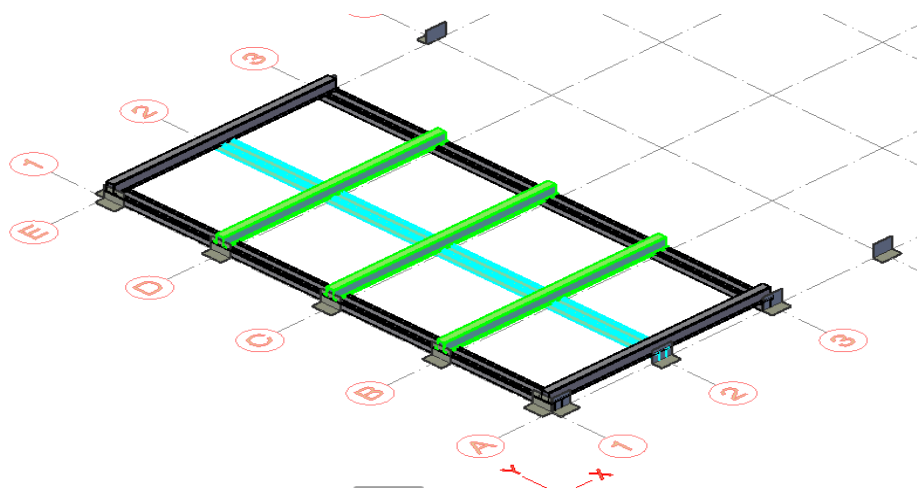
Isometría de Panel de 1.220mm x 2.460mm Colocado en Piso
